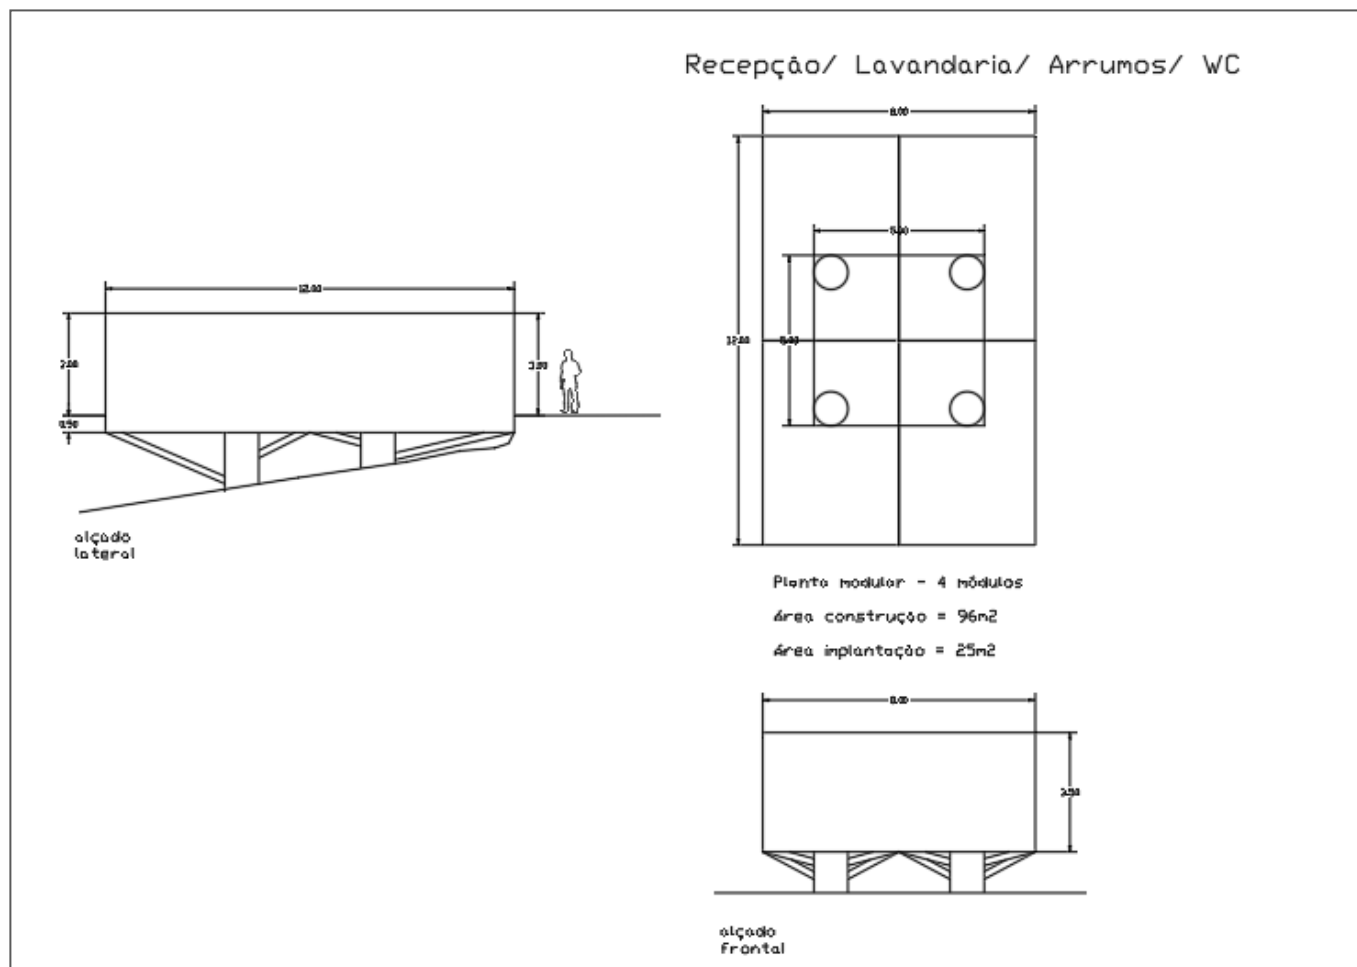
Planta e alçados do edifício de recepção/ serviços de apoio (sem pórtico)
